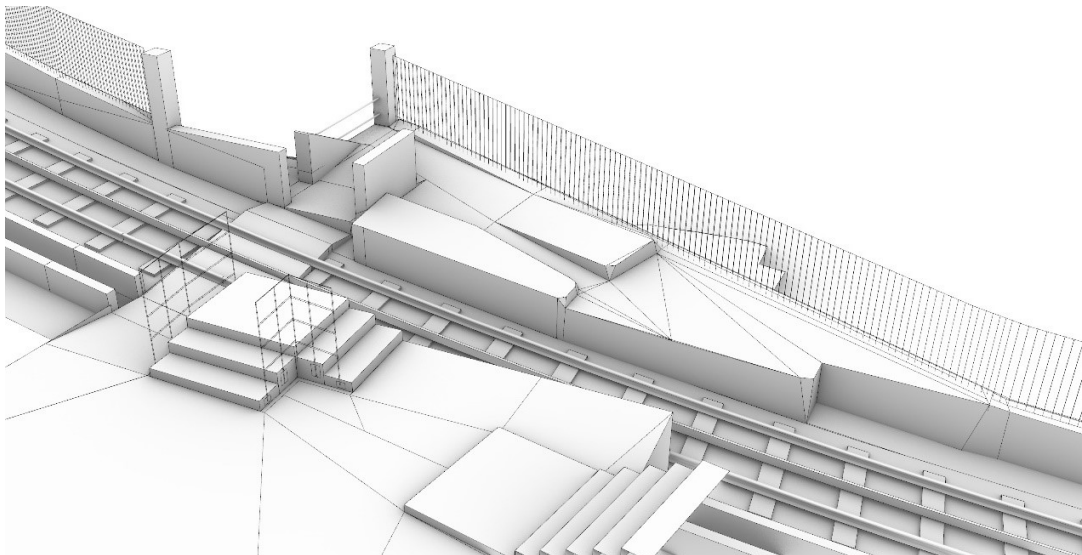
Fermata Centurione - stato attuale - Vista da W-SW
